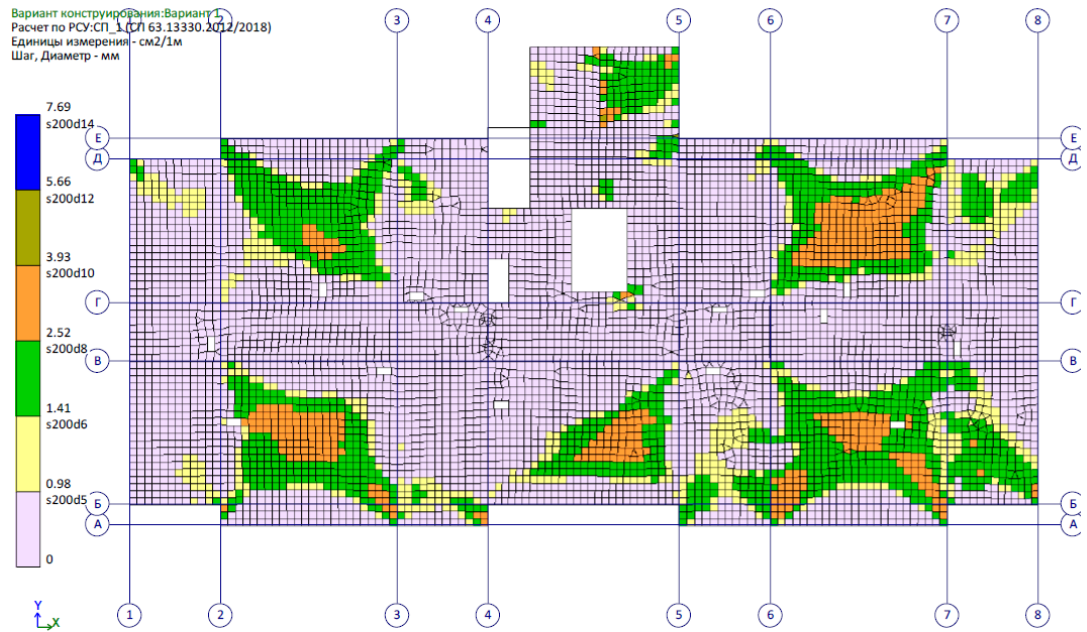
Площадь полной арматуры на 1пм по оси Y у нижней грани ПЛИТЫ
